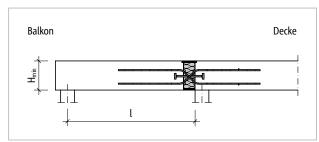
Schöck Isokorb® T Typ QP-VV: Statisches System
